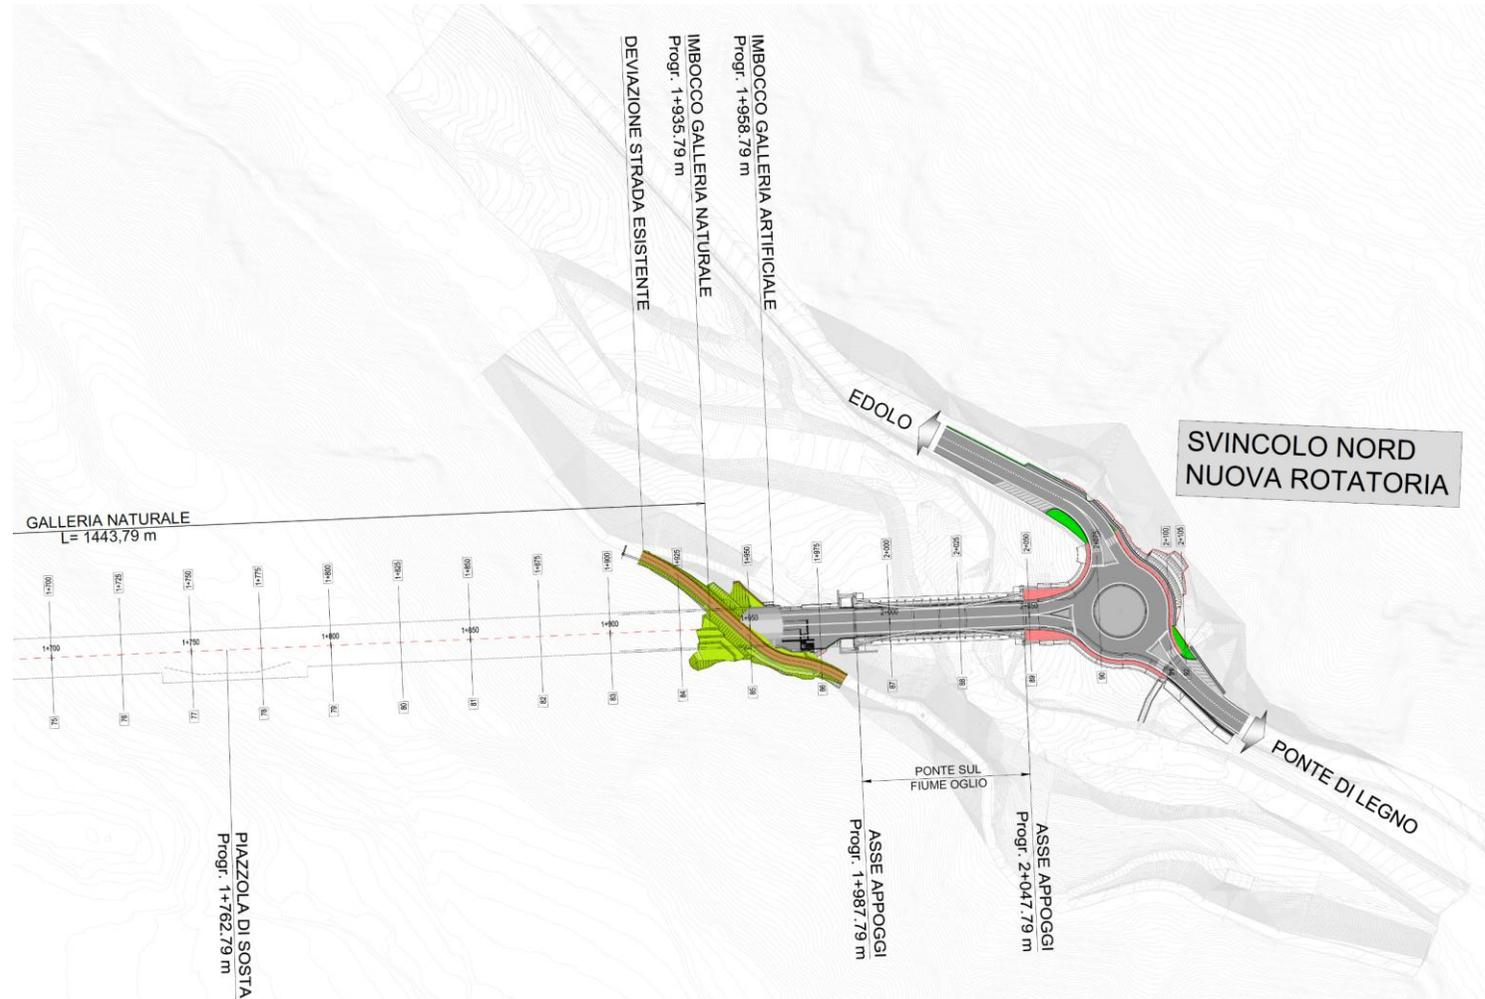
Schema planimetrico tracciato - Tratto Nord
